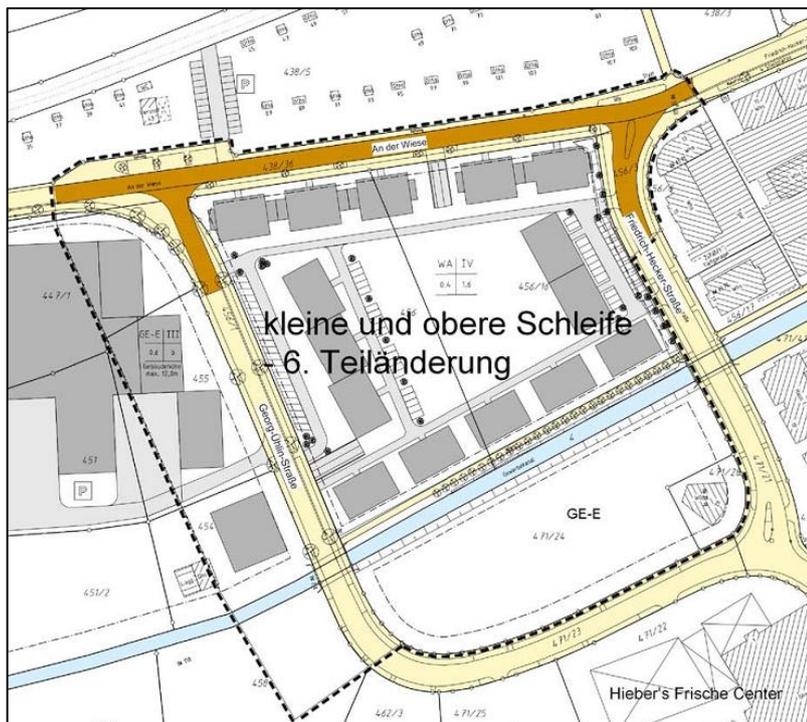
Bebauungsplan "kleine und obere Schleife - 6. Teiländerung" - Entwurf der Stadt Schopfheim, Plandatum: 06.02.2013²⁰
